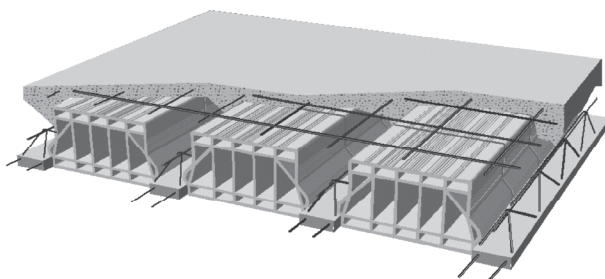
Esempio di solaio in calcestruzzo o armato a travetti tralicciati e blocchi di laterizio interposti²
